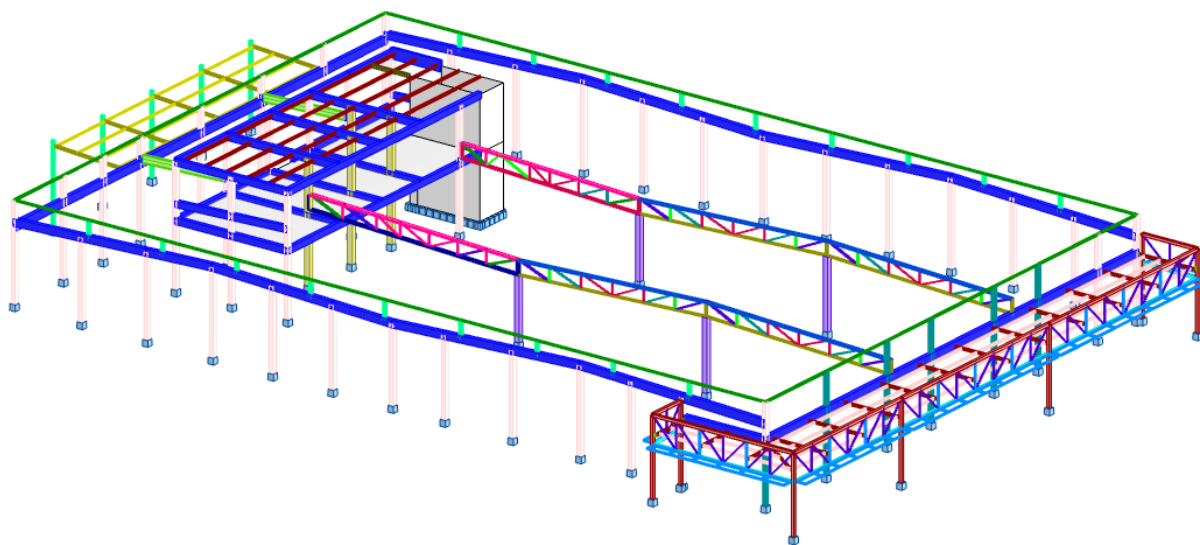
Vigas de betão armado da estrutura, assinaladas a azul.
